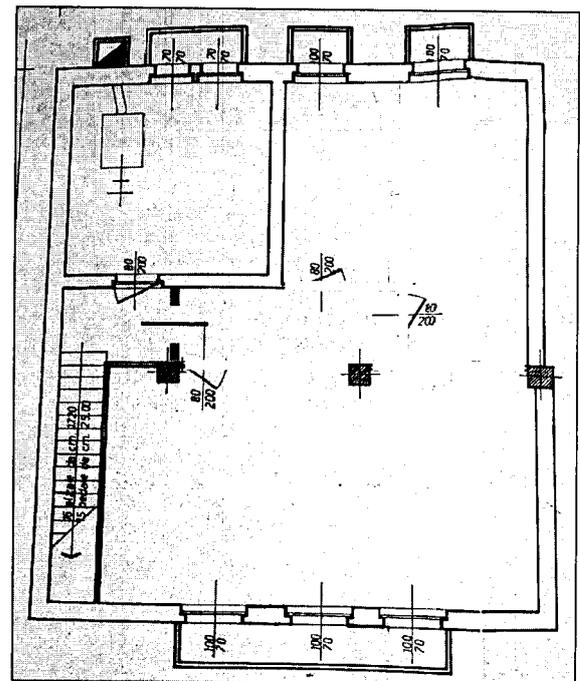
Stato rilevato al sopralluogo del 24.03.2023
